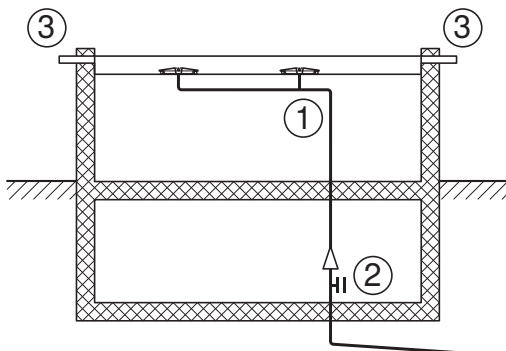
Naissances d'eaux pluviales et tracé de conduite en cas de chéneaux encaissés
